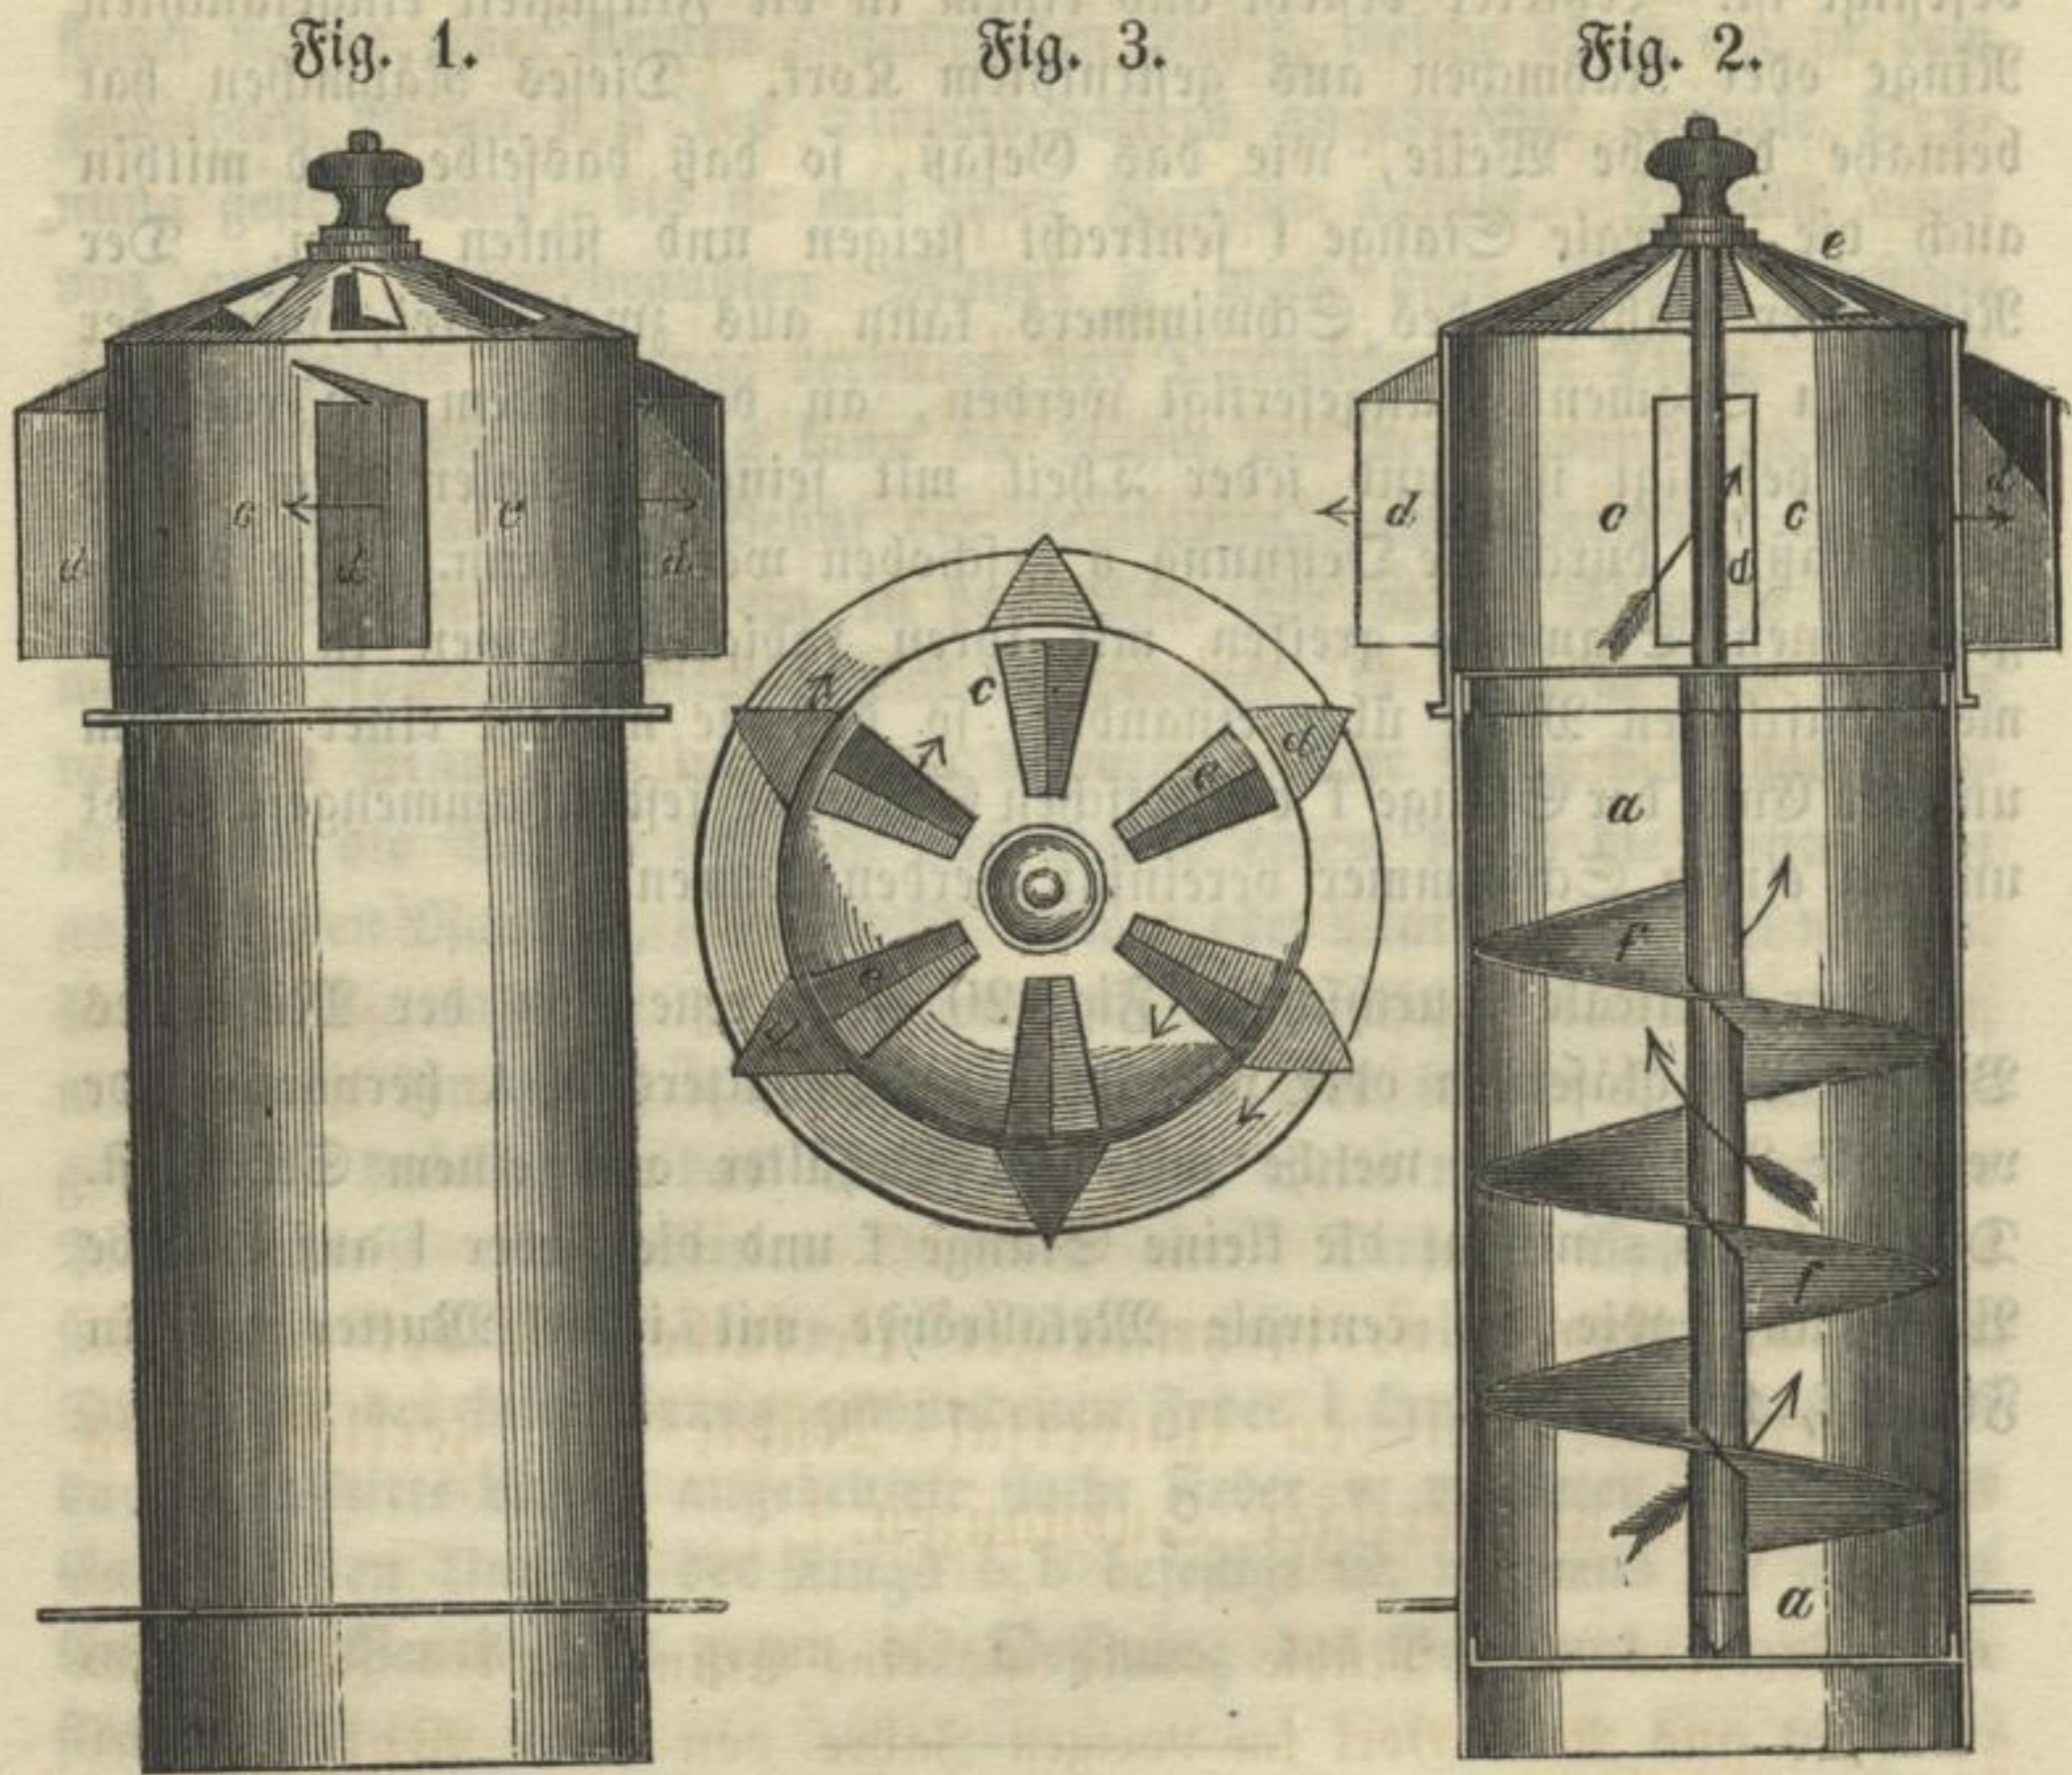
ist eine äußere Ansicht, Fig. 2 ein senkrechter Durchschnitt und Fig. 3 ein Grundriß dieser Schornsteinkappe. a ist deren Körper (oder unteres Gehäuse), welcher den Canal für den austretenden Rauch, Dampf ic. bildet; er wird wie gewöhnlich oben auf dem Schornstein befestigt. c, c ist eine rotirende Schornsteinkappe, auf einer Spindel
